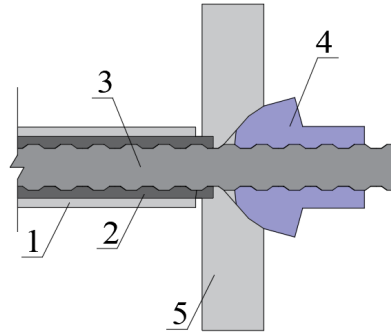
Схема преднапряжения канатной арматуры без сцепления с бетоном
